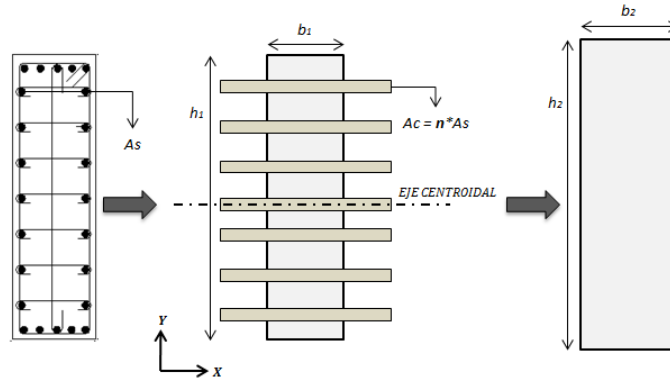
Modelo analítico para secciones de columnas en concreto reforzado.
